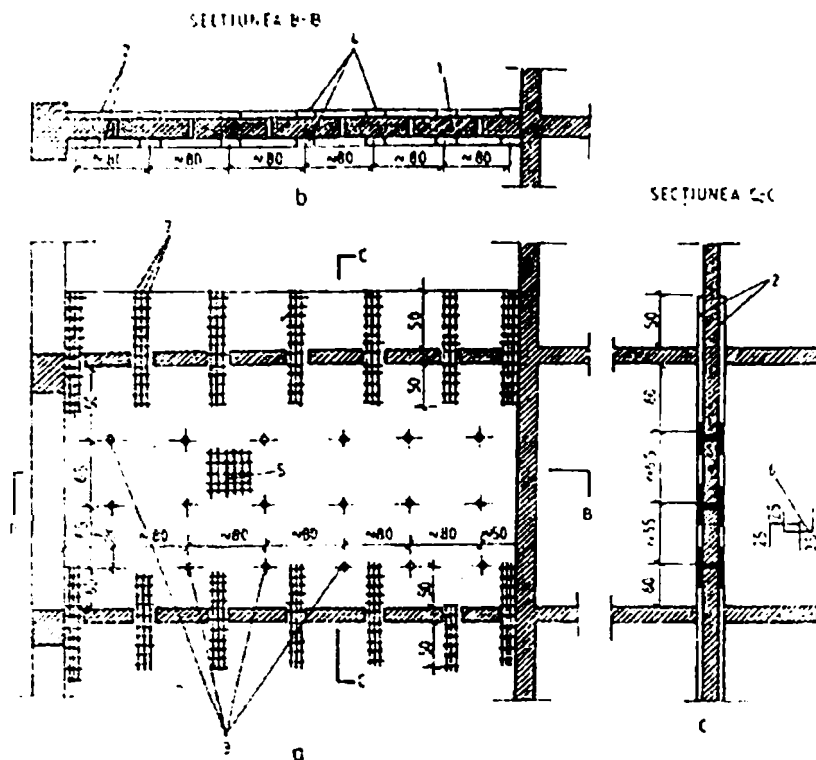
Detaliu consolidare diafragma din beton armat monolit; a-elevatie; b-sectiune orizontala B-B; sectiune verticala C-C; 1-diafragma de consolidat; 2- zona torcretata de min. 5 cm; goluri date in diafragma; 4-gauri practicate in placa; 5-plasa armatura; 6- bare de legatura; 7-scarita din otel beton
